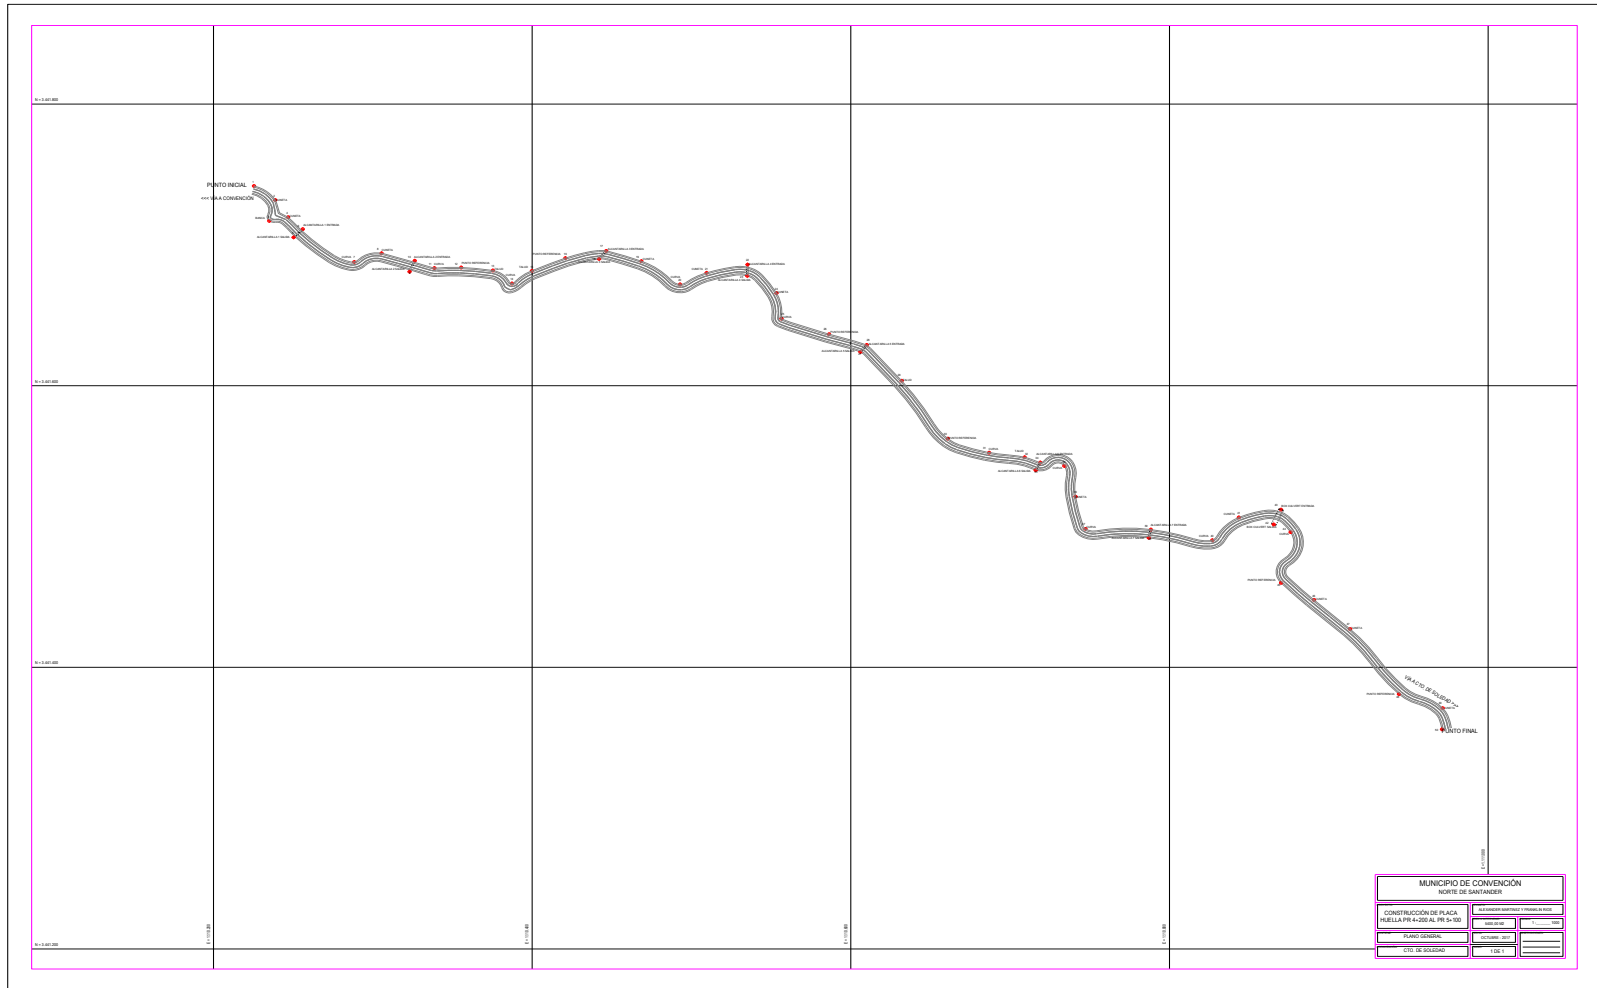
Plano en planta placa huella PR4+200 al PR5+100
